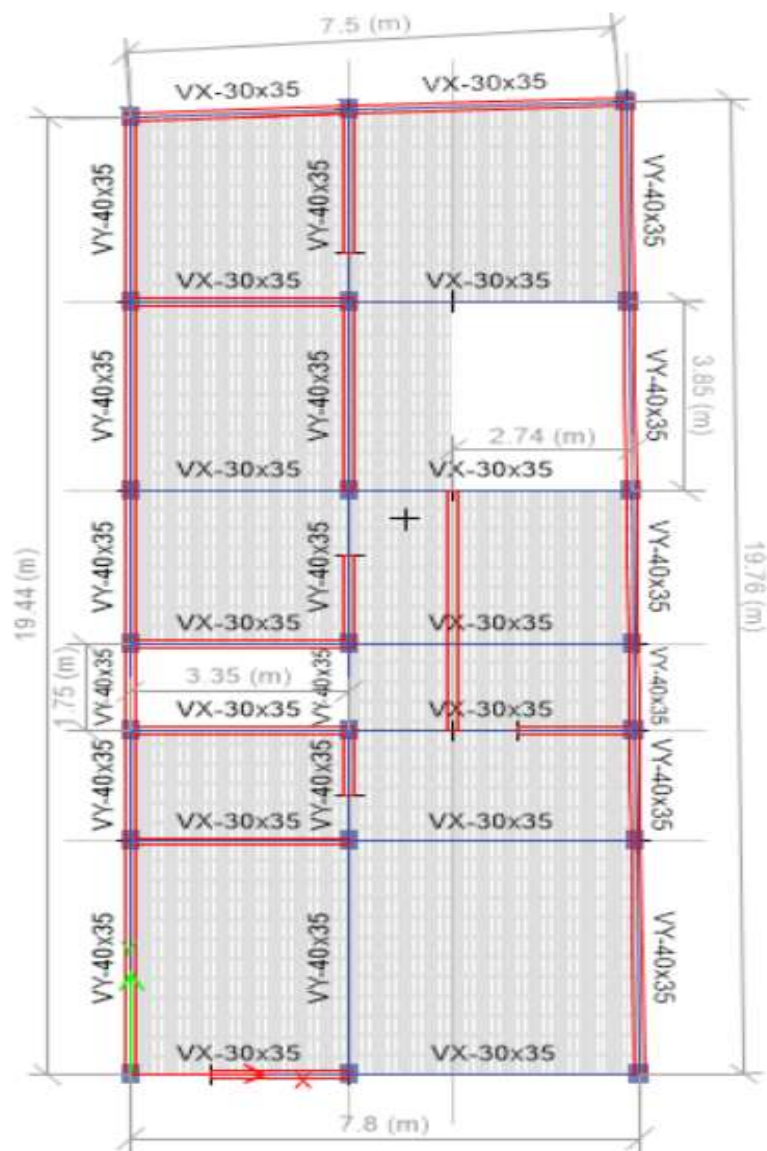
Estructuración en planta en Etabs de la vivienda N°02
